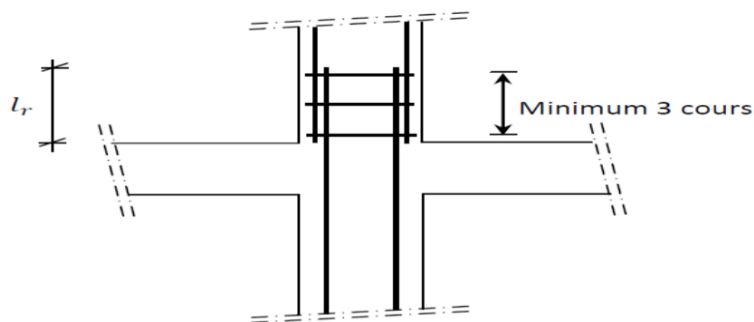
Les armatures transversales dans la zone de recouvrement
